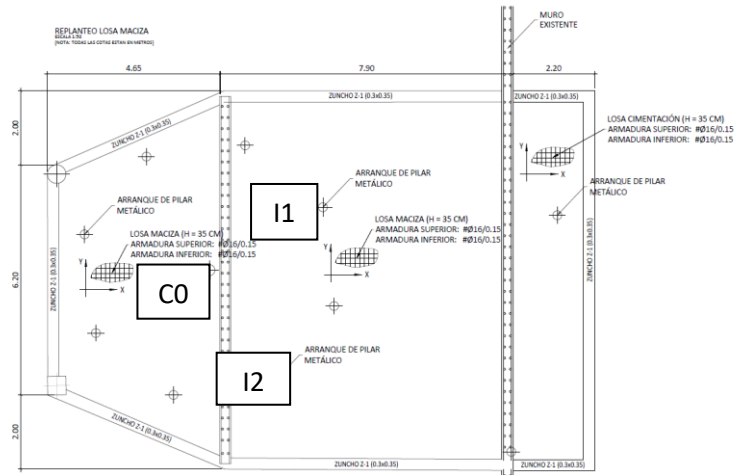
Losa de 35 cm, posición de pilares y muros. Fuente: Proyecto instalación de parque Multiaventura sobre forjado del centro comercial LAGOH en Sevilla
